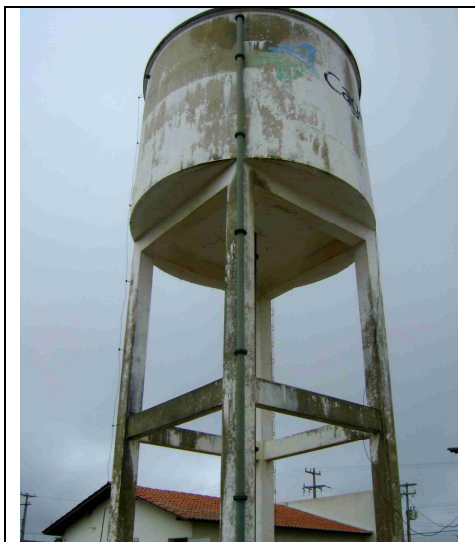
RAP-08: Vista das tubulações de ventilação.
